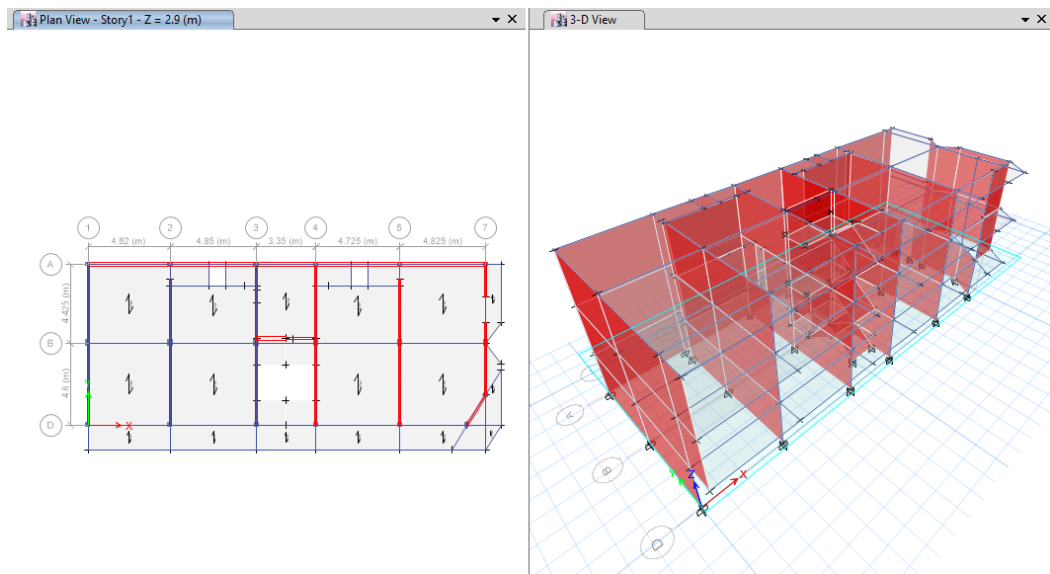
Modelamiento en planta y en 3D de la edificación en el ETBAS v.16
